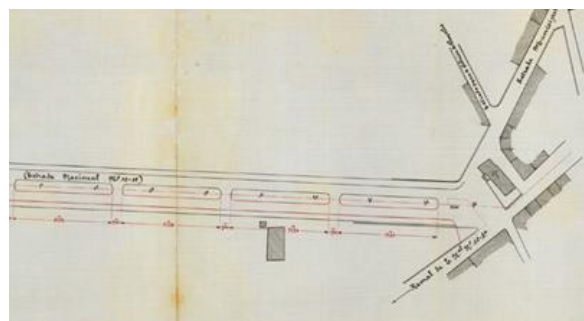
| Extrato da planta onde é visível o término da Avenida junto à capela de Stº Ovídeo.
